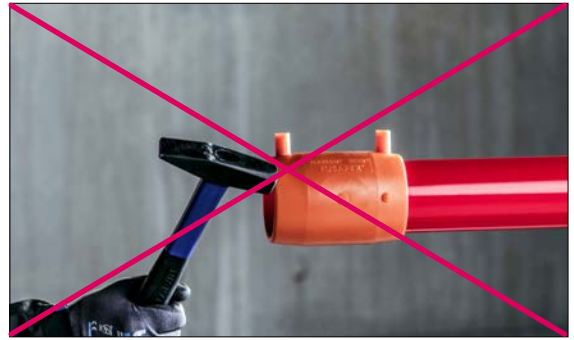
Elektroschweißmuffe nicht gewaltsam aufreiben.
